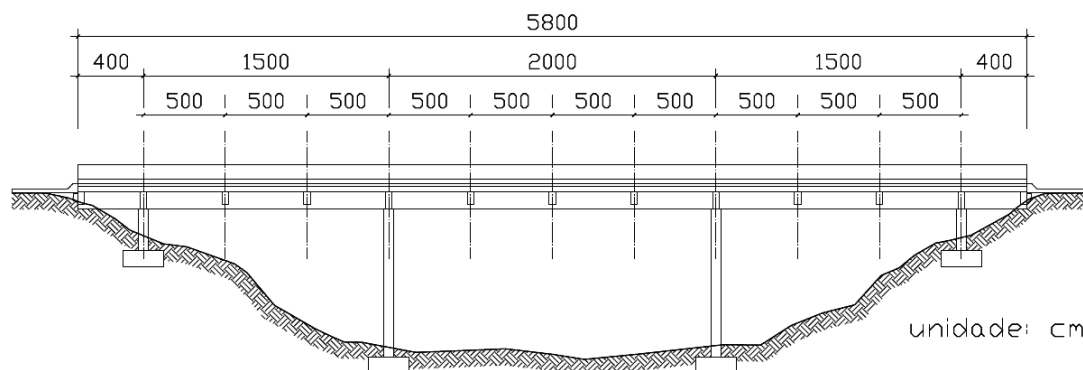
Esquema longitudinal, em vista, da estrutura da ponte do exemplo.
